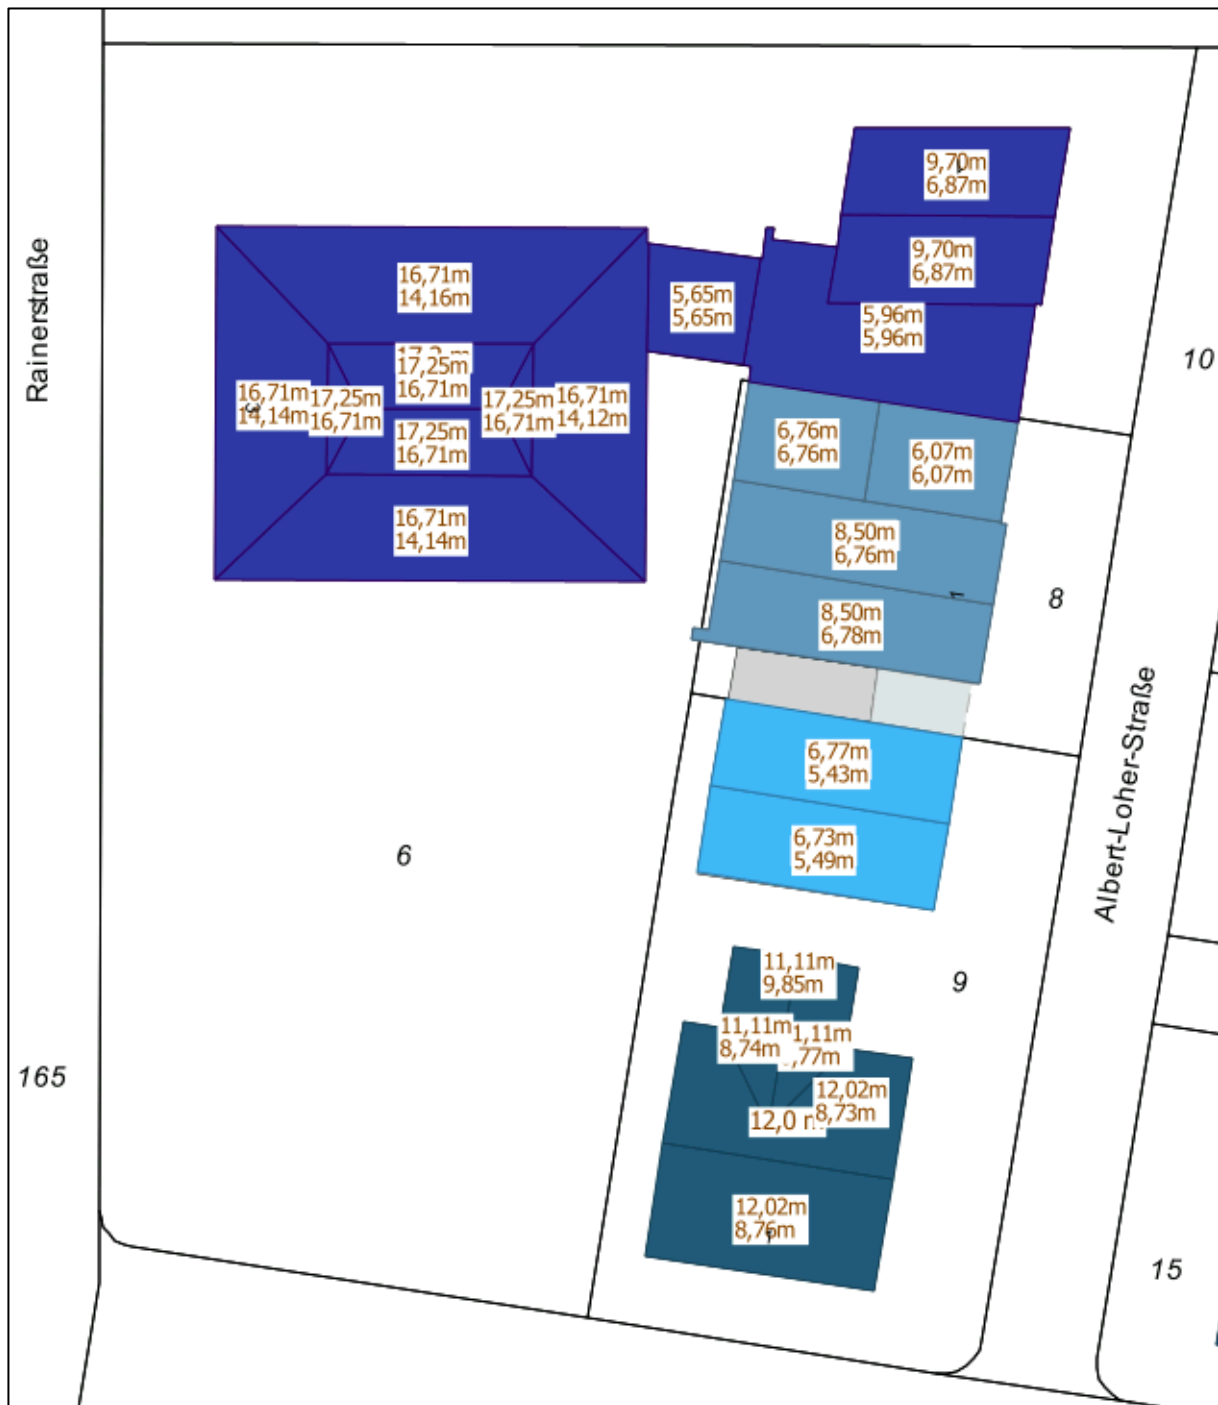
Wand- und Firsthöhen der Bestandsgebäude; Quelle: RIWA GIS, 2024
